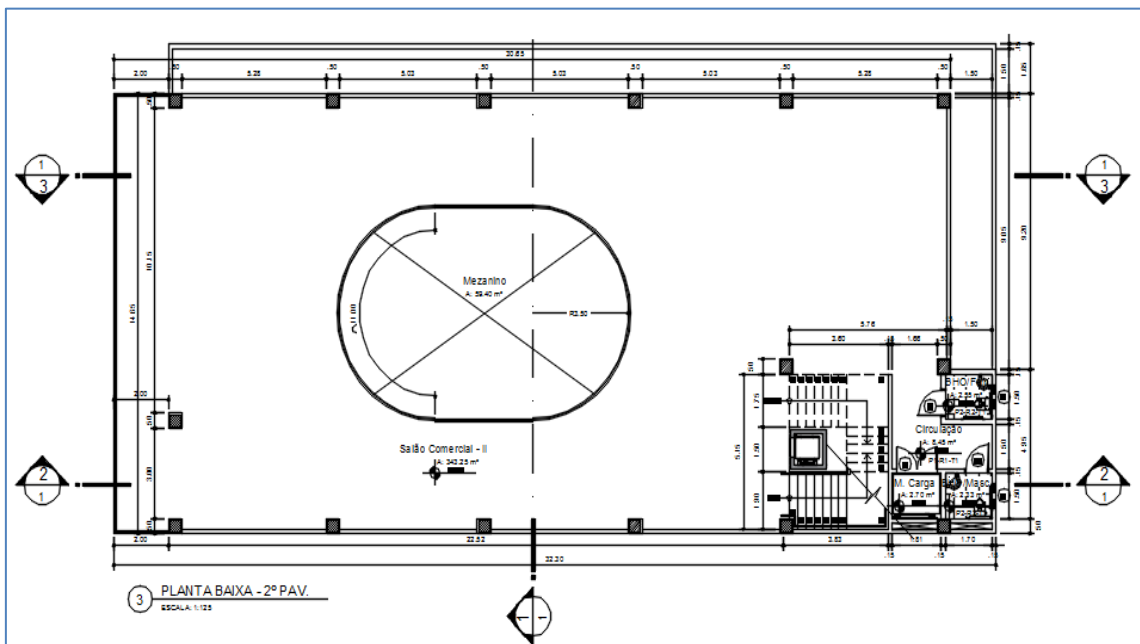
Planta baixa: 2º pavimento (autor do projeto arquitetônico)
